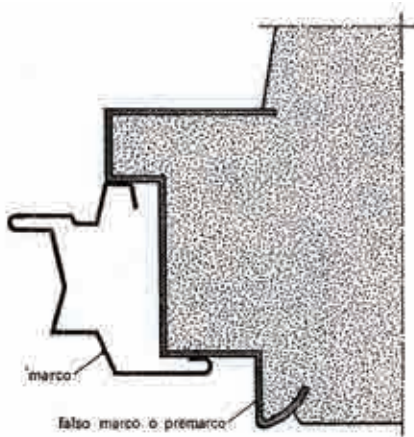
Premarco de acero embebido al panel de hormigón (Tecnologías de la construcción industrializada' G.Blachère)
